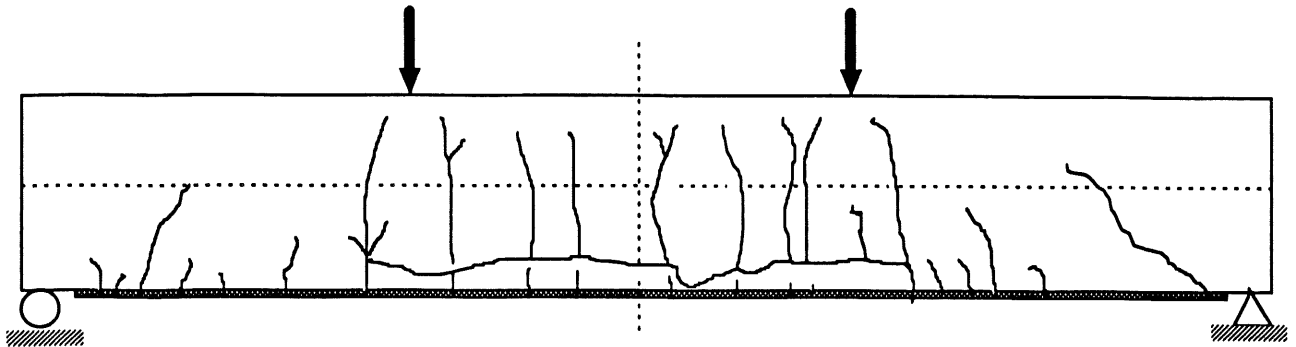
État de la fissuration à la rupture de P0
